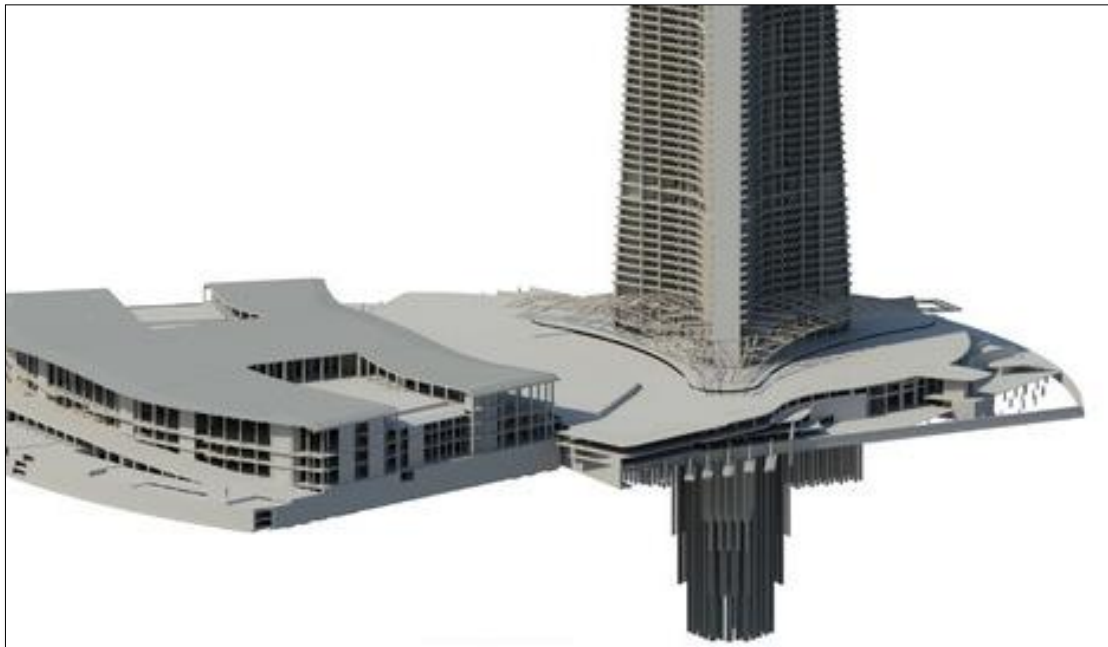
Infrastructure de la Kingdom Tower, (Radier + Pieux de soutènements)
